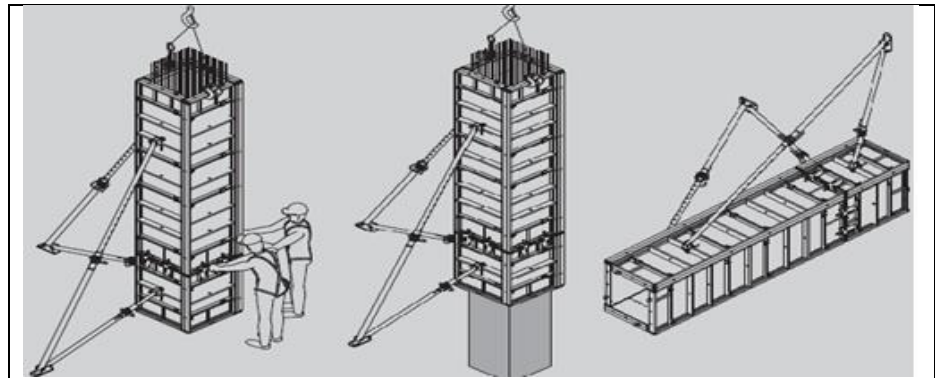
Desmontaje del encofrado de columnas con grúa
